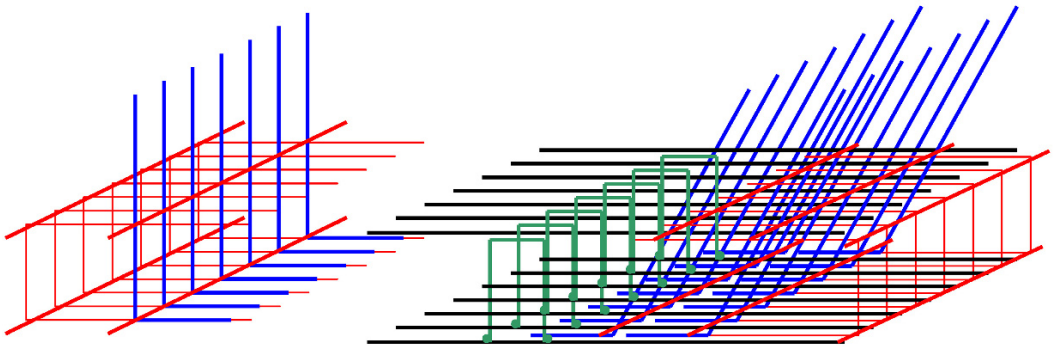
Plattenkanten im Prinzip mit den Eck- und Kehlpositionen (dick-rot)
